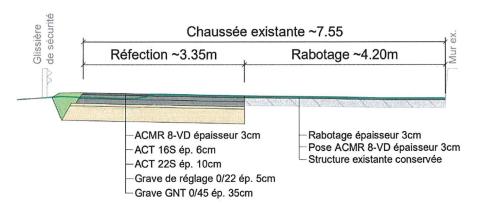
Coupe-type remplacement du coffre de chaussée et rabotage
